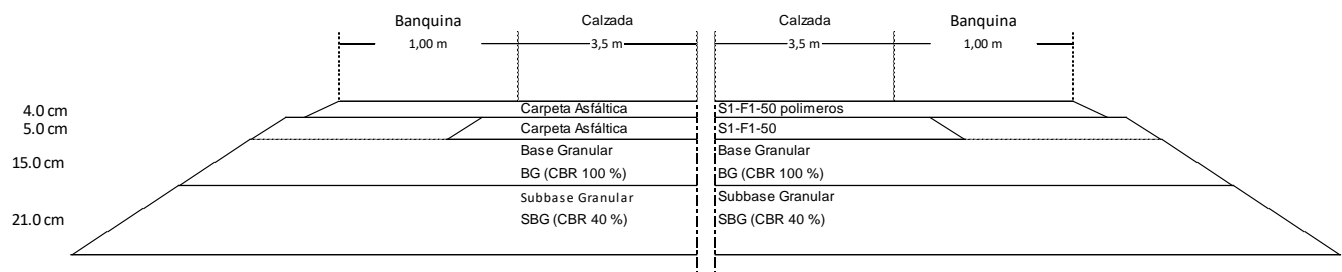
Estructura de pavimento propuesta en la totalidad del trazado
